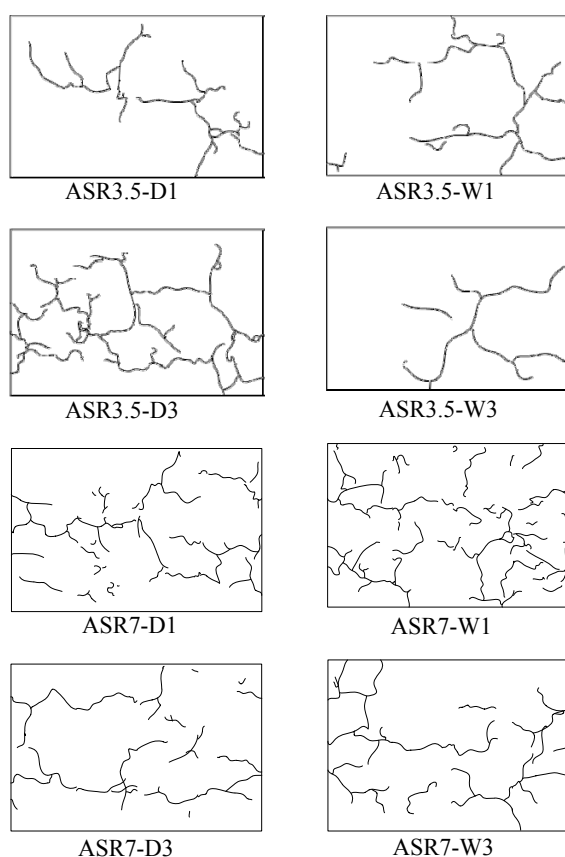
ひび割れ図 (円柱供試体側面展開)
